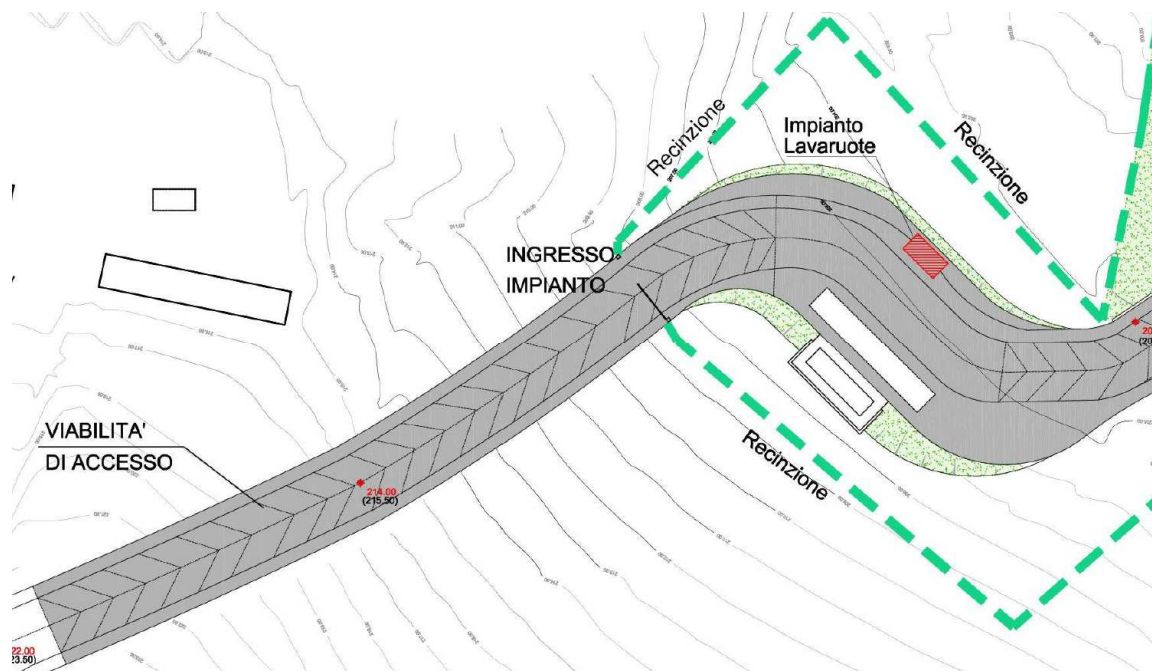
Posizione dell'impianto lavar ruote all'ingresso dell'impianto
